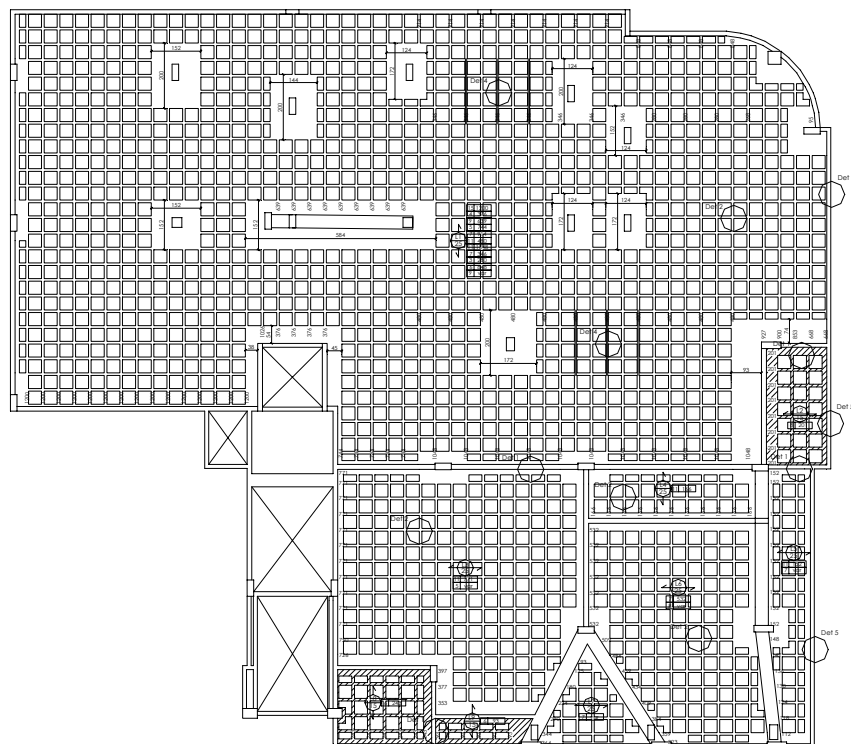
Laje sem vigas (Projeto: Eng. Giovanni Brisot, Msc. –RCA Engenharia de Estruturas).
